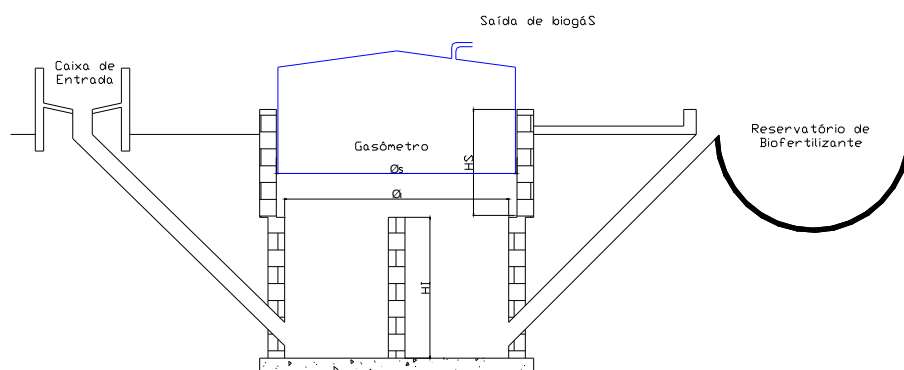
Corte longitudinal do biodigestor utilizado
